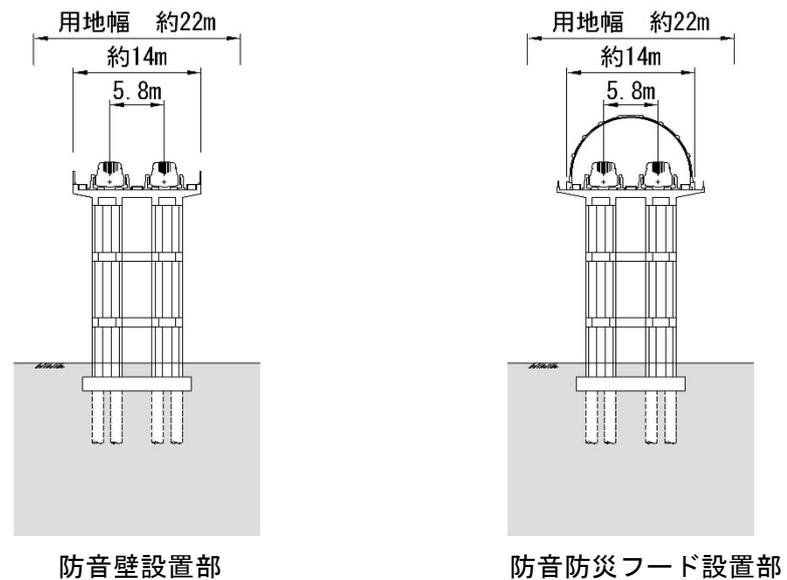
標準的な高架橋（新形式高架橋）の断面図
